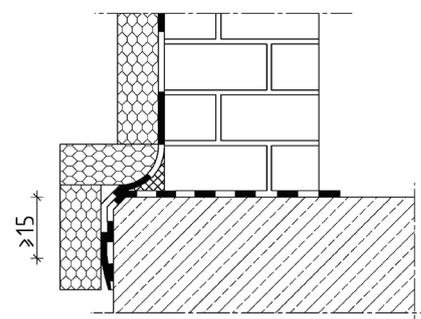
Abdichtung mit KMB im Bereich der Stirnseite der Betonbodenplatte bei der Wasserbeanspruchung »aufstauendes Sickerwasser«
